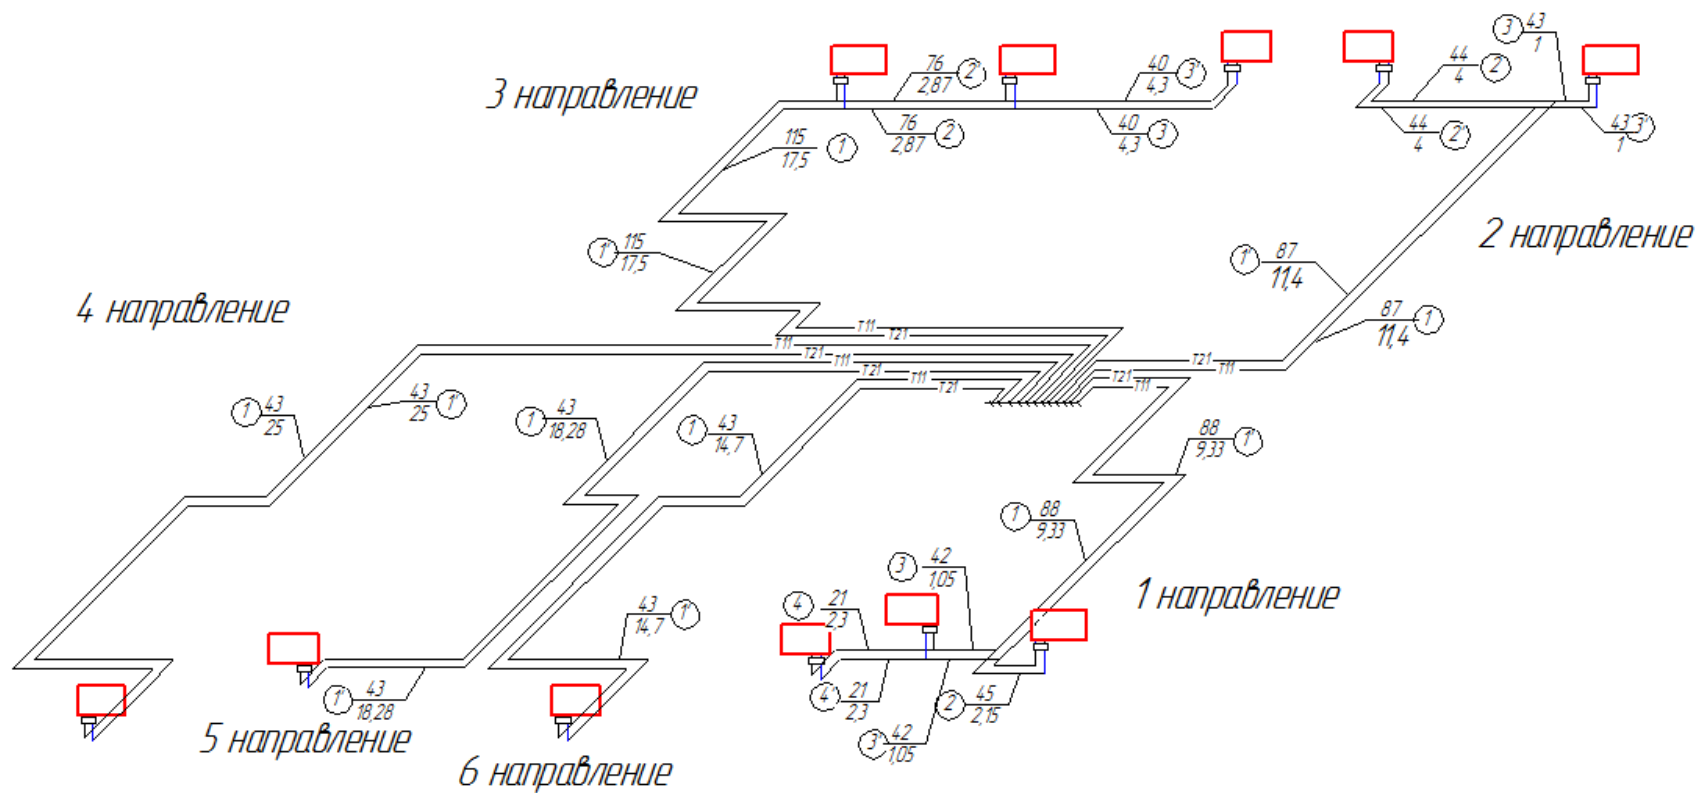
Расчетная схема поквартирной разводки 1,3 этажа (БС-1)
